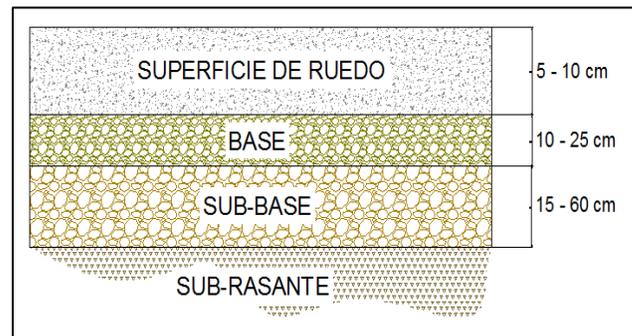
Estructura del pavimento semi-rígido (Autor, 2013).
